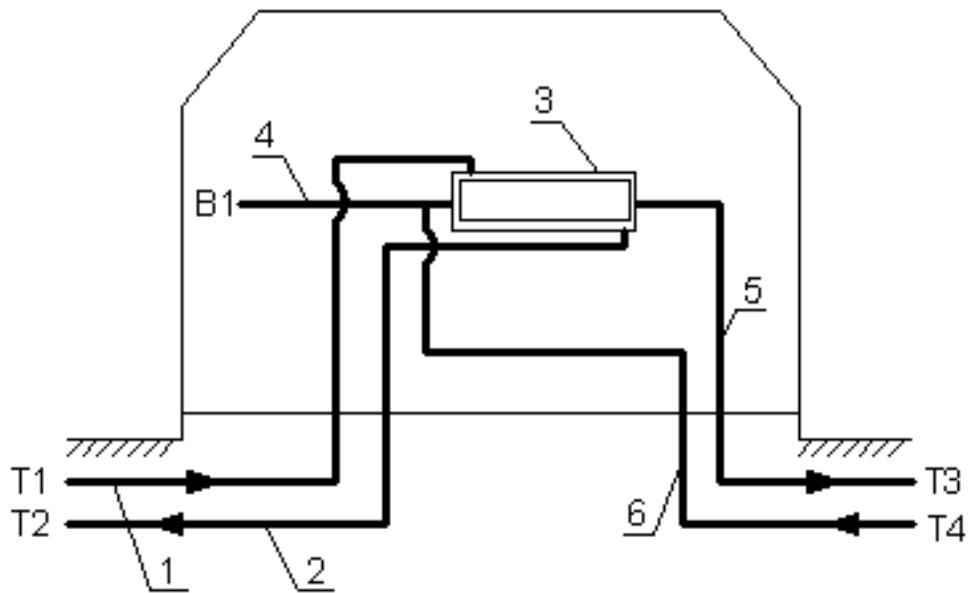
Схема ЦТП при закрытой схеме горячего водоснабжения:
